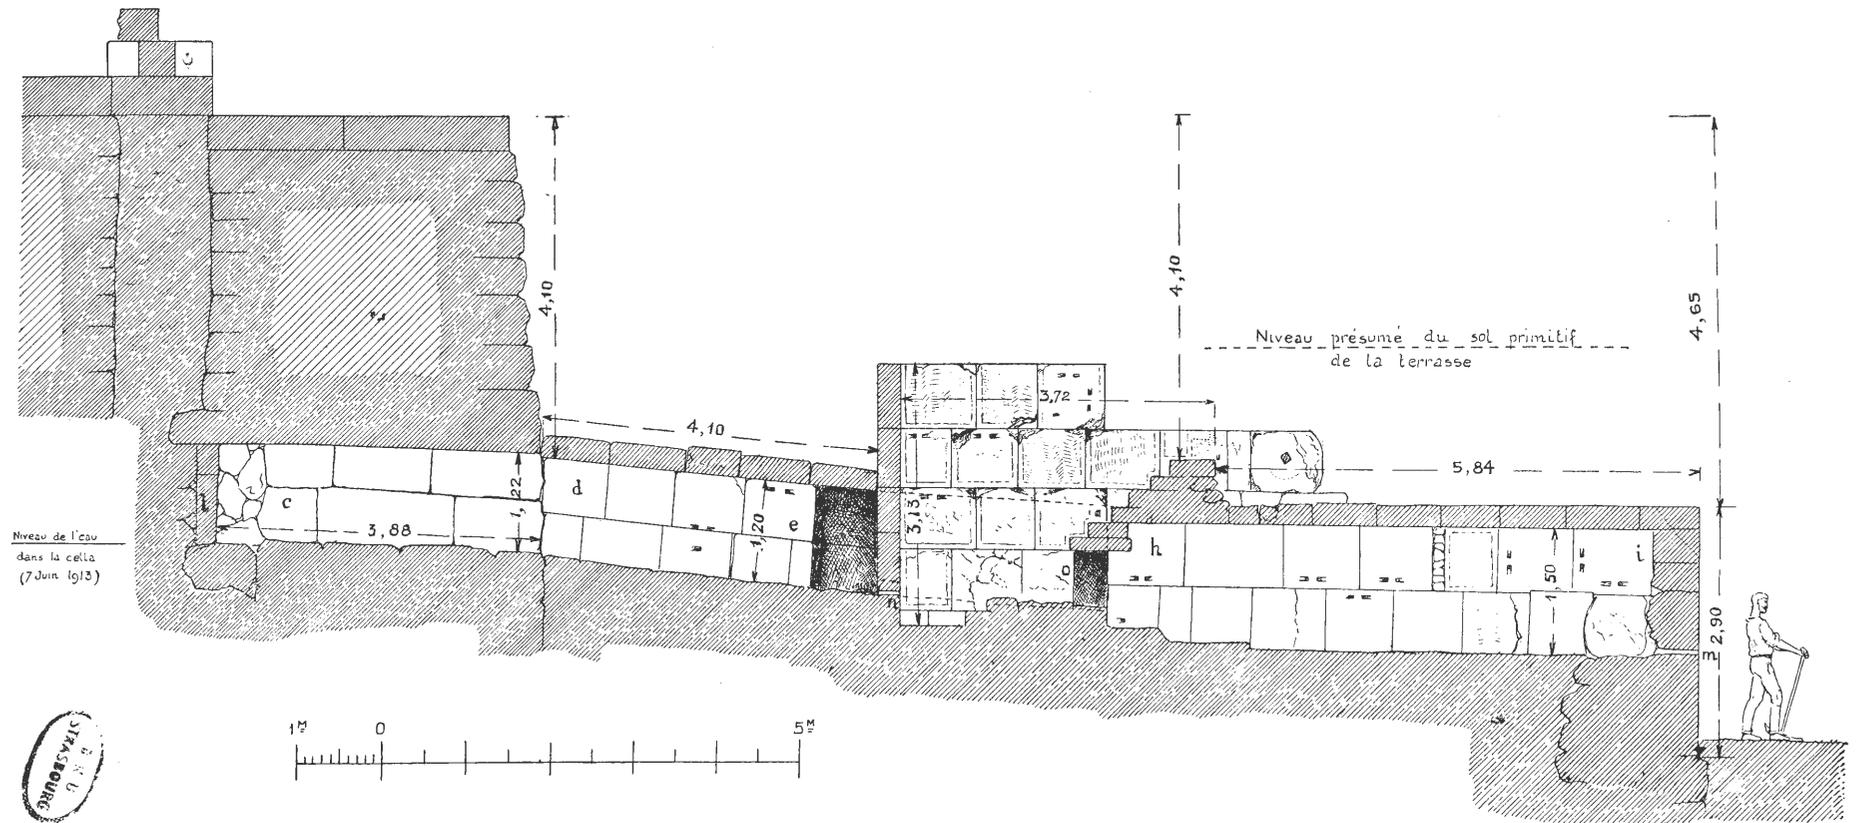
Plan (état actuel) de la fontaine et des conduites.
